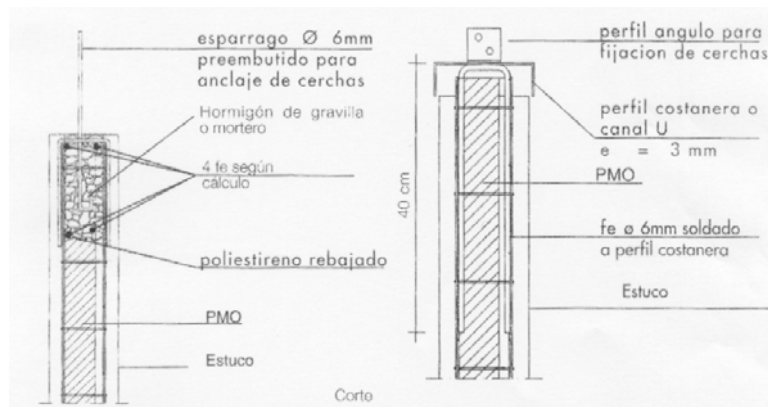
Soluções para apoio de coberturas em betão e metálicas
